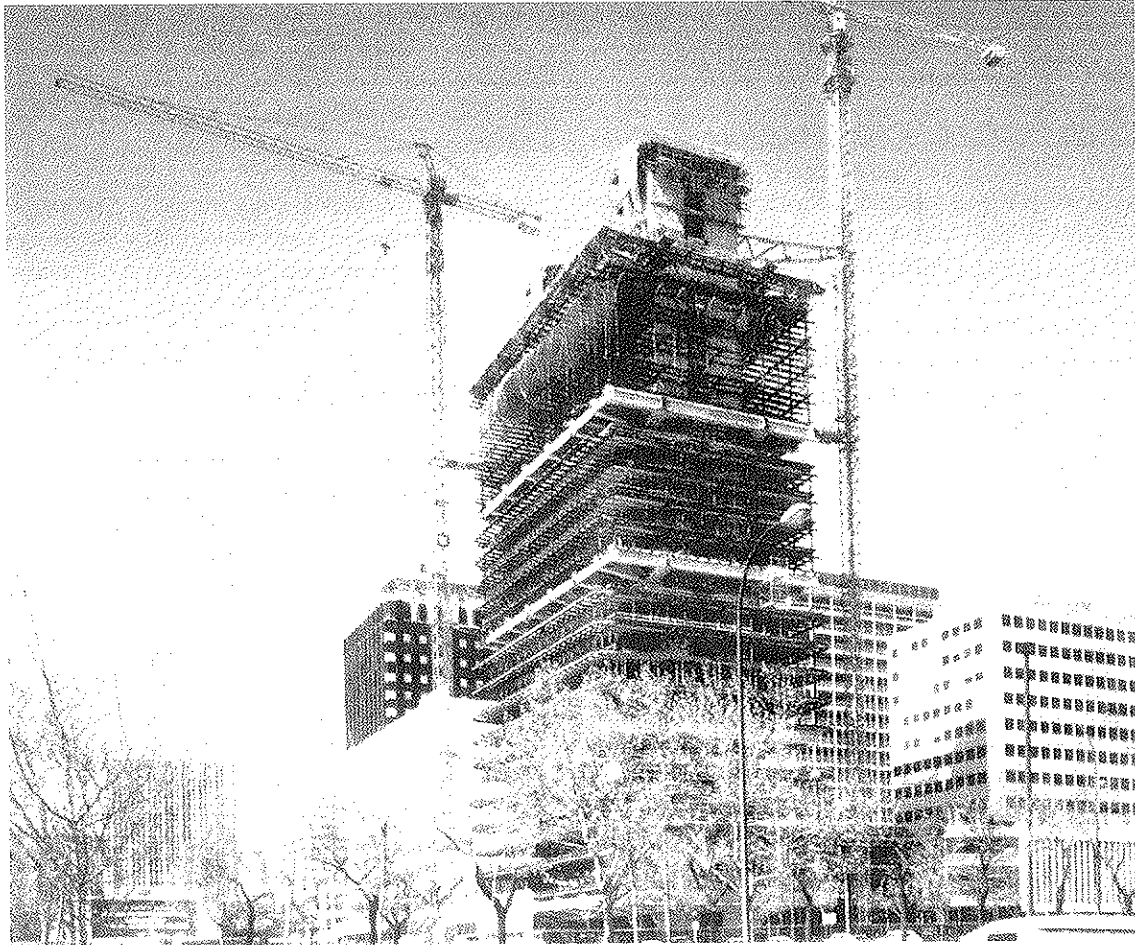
Edificio del BBV en el Paseo de la Castellana (Madrid), en construcción. Pueden verse las plataformas de hormigón postesado, que sirven de apoyo para las estructuras metálicas de las plantas superiores.
